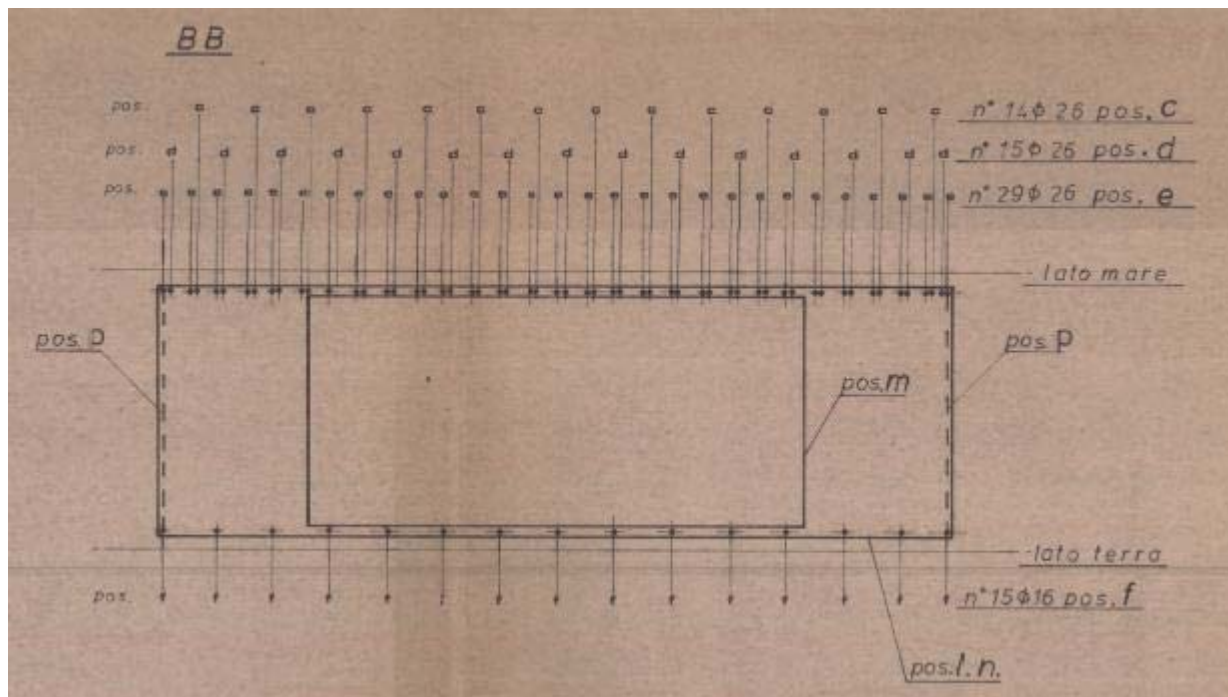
Sezione ed armatura nel tratto di massima sollecitazione del diaframma (da progetto del 1979)
